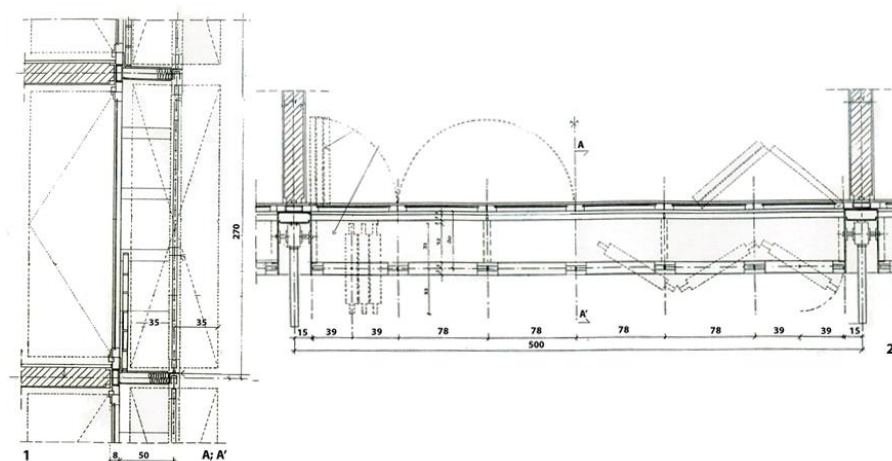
Batentes exteriores; pormenores construtivos tipo: 1) Secção; 2) Planta.
